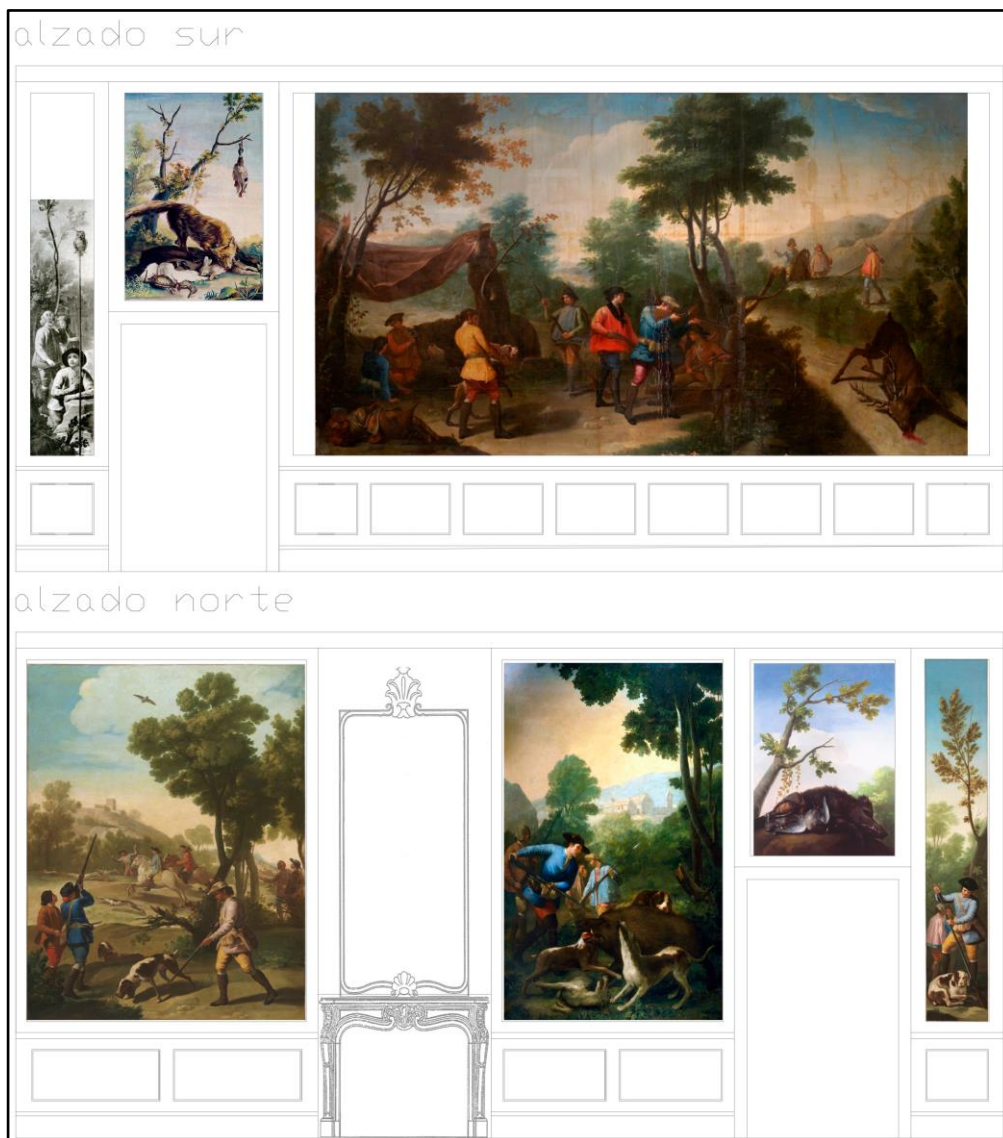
Reconstrucción de los alzados norte y sur de la Pieza del Comedor, según los autores (alzados realizados por Diego Ruiz-Vernacci Lozano).
